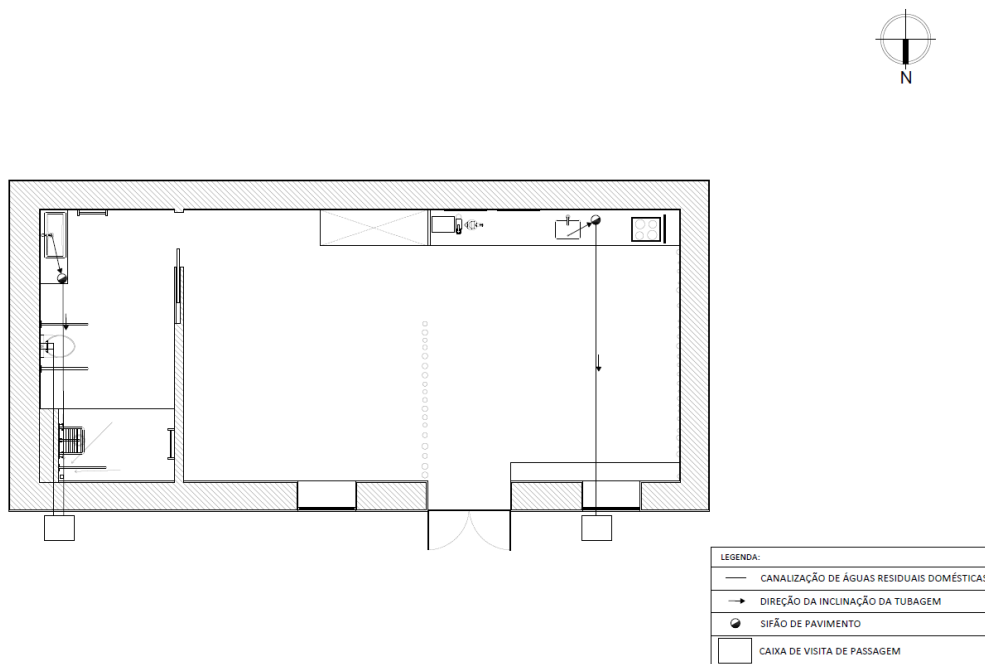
Planta de Esgotos, Alojamento Til, Piso 1.
